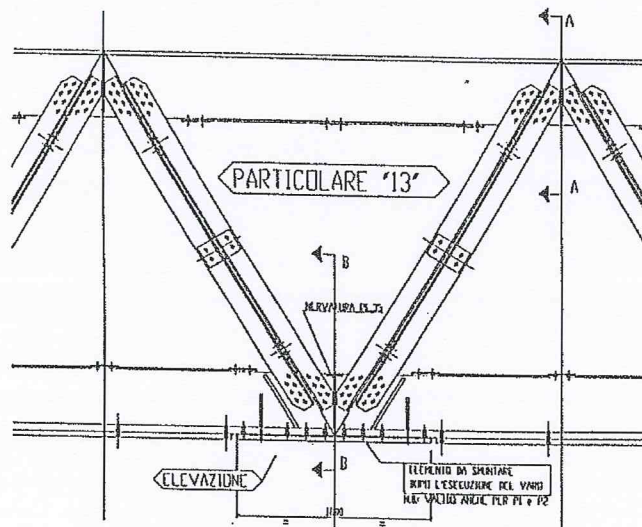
Particolare collegamento diagonali-briglia sulla pila.
